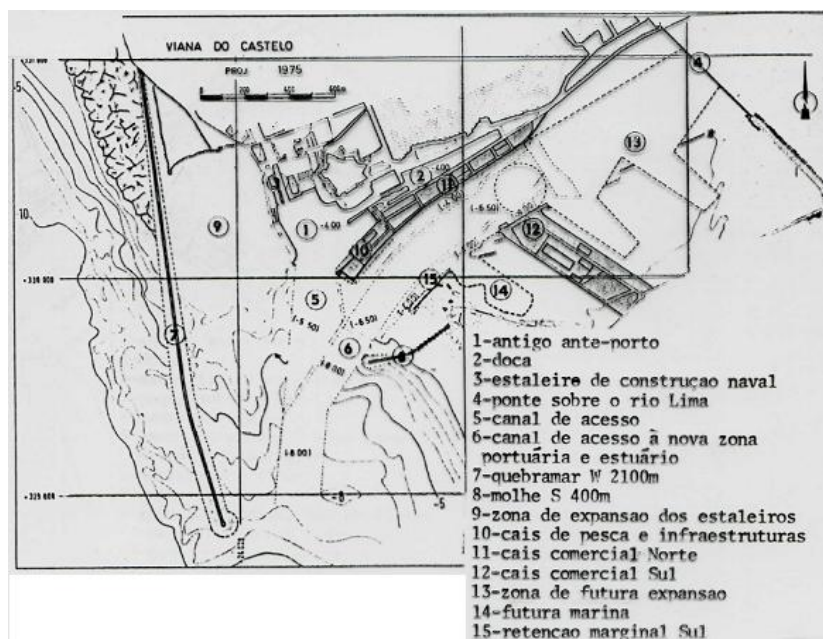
Planta do Porto de Viana do Castelo, 1975.
